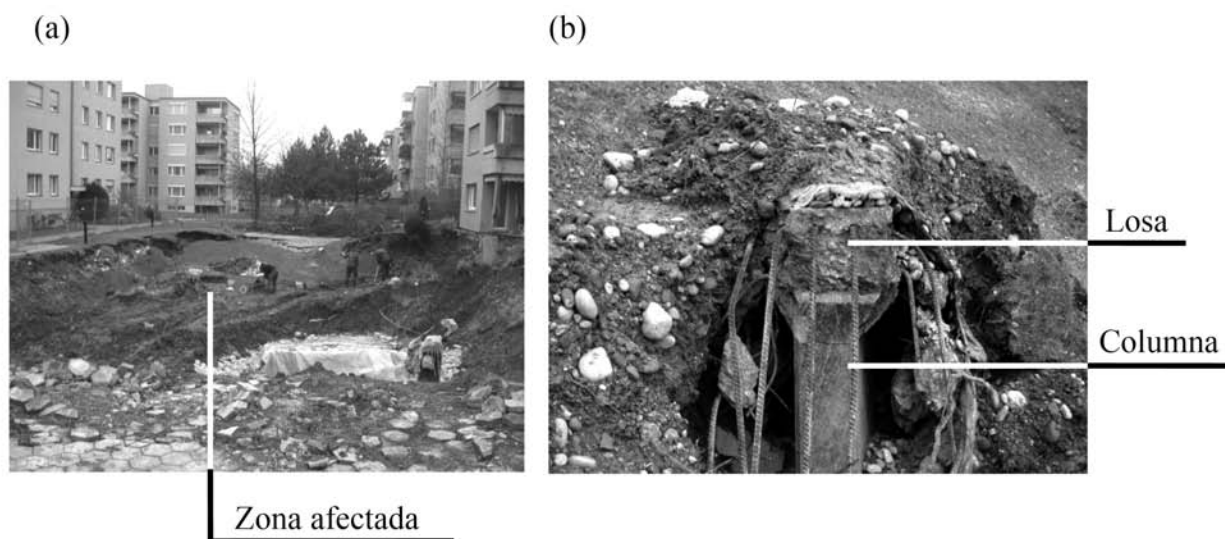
Derrumbe de la losa de cubierta del parking de Gretzenbach (Suiza) en 2004
